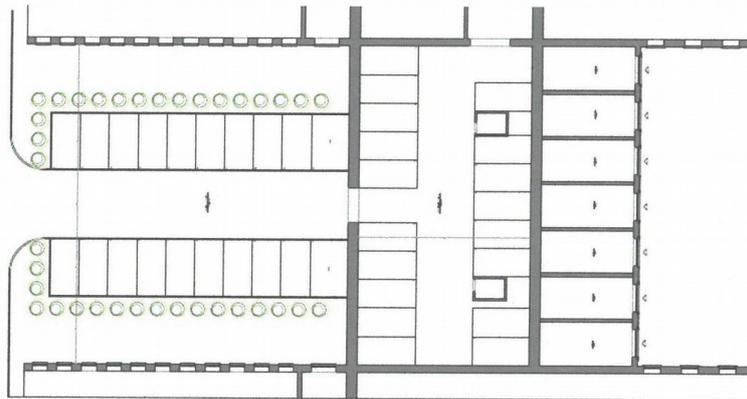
Esquisse d'aménagement en plan de la cour et du rez-de-chaussée.
